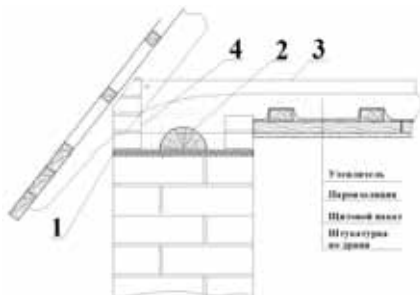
Устройство чердачного перекрытия: 1 – гидроизоляция; 2 – обвязка из пластин по периметру здания; 3 – балка перекрытия; 4 – закладка между балками керамическим кирпичом
